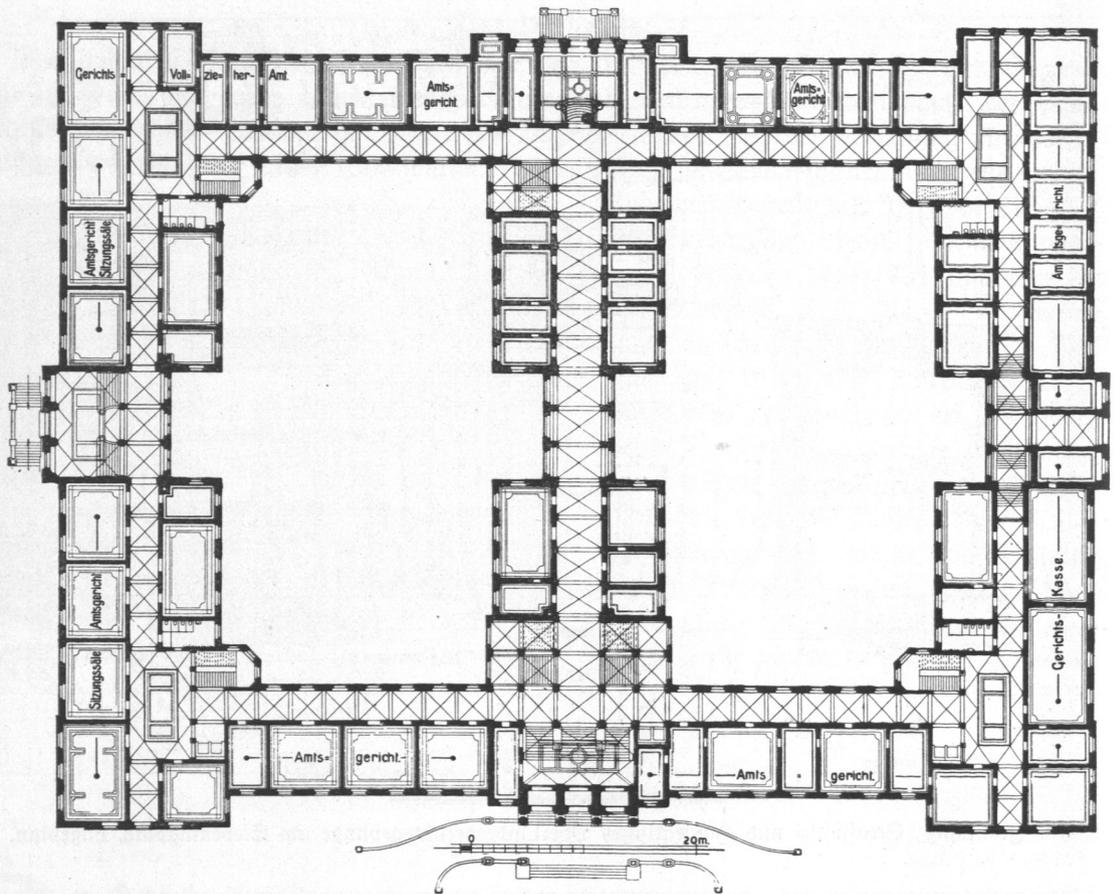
Ziviljustizgebäude, Grundriß, Erdgeschoß.
